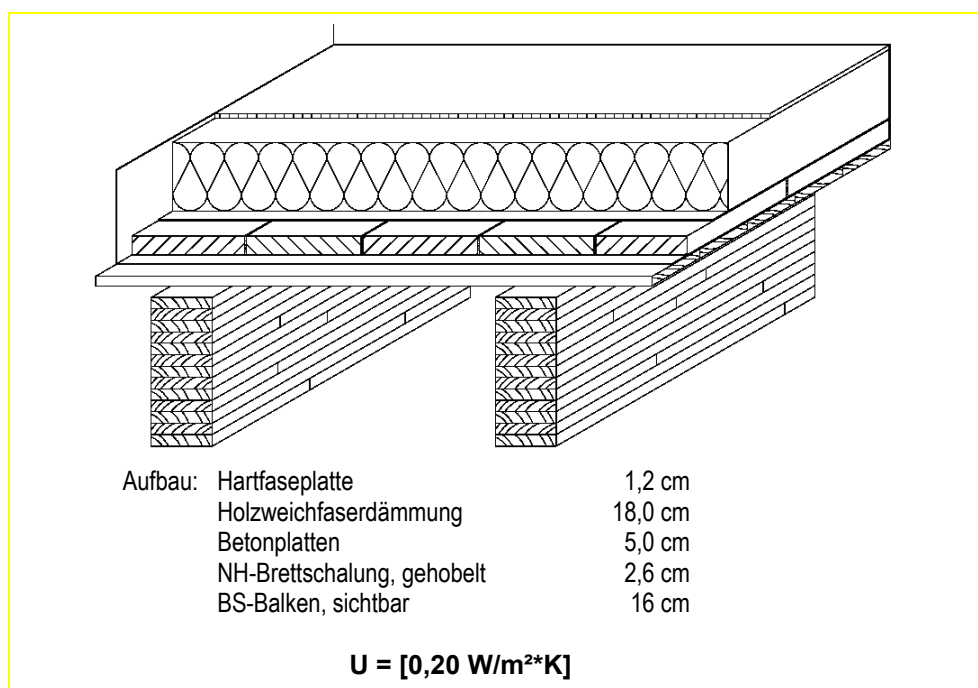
Komplettaufbau gedämmte Decke zum Dach, unbelüftet, sichtbare BS-Balken (SIR 2002, Element-Nr. 135049923)
